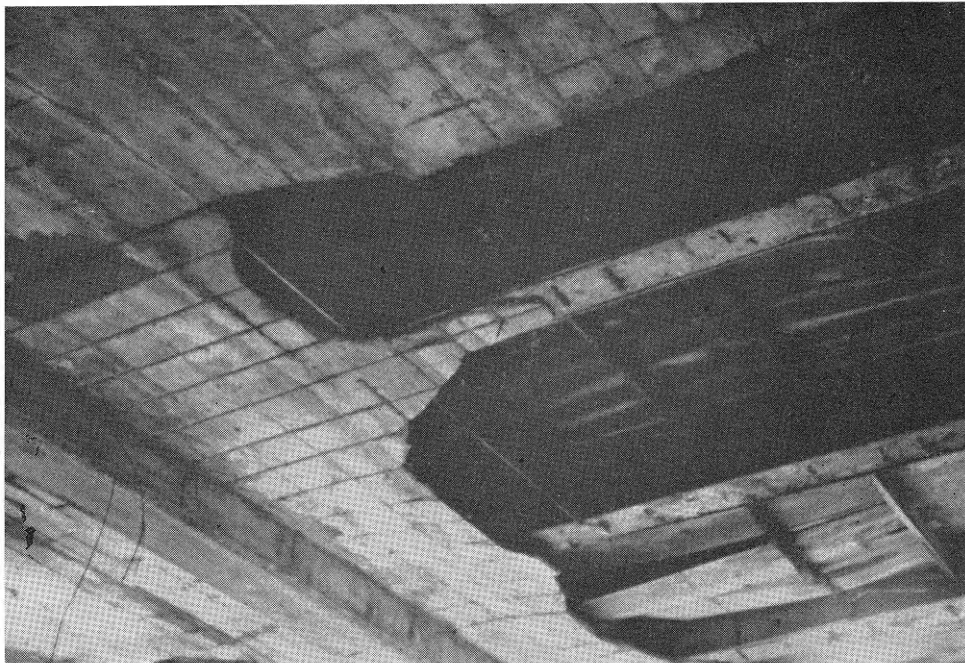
Derrumbamiento, a trechos, de una placa del tipo de cajón perdido. Se trata de placas de cubierta sometidas a la condensación. La armadura fue corroída intensamente en las fisuras, llegando al colapso.
